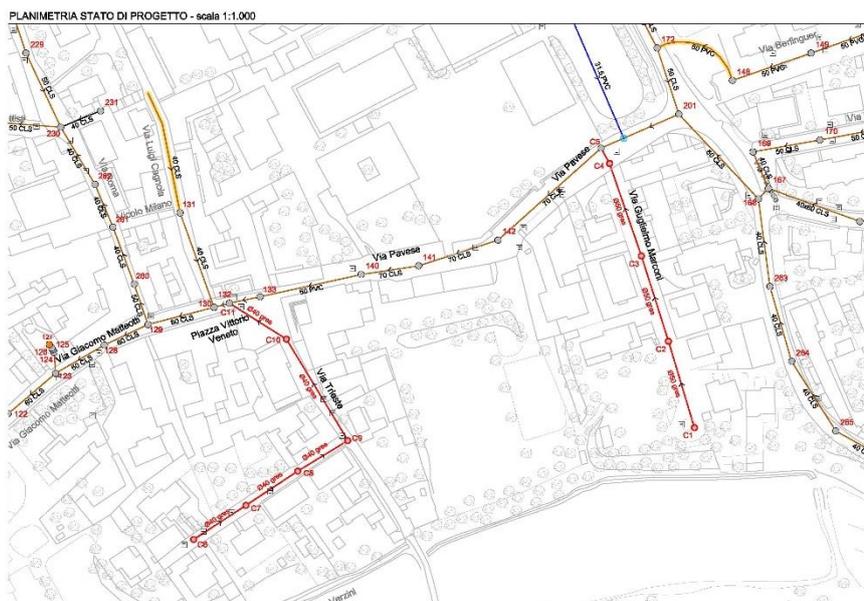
Stralcio di Progetto via Marconi e via Trieste
